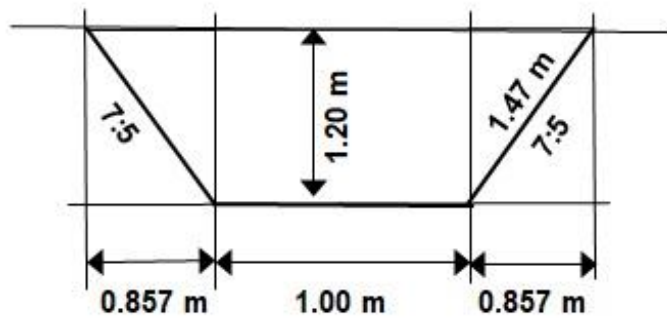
; Ausschnitt aus Plan Haltungen Generellen Entwässerungsplanung (GEP) Berechnung (ohne Massstab)
